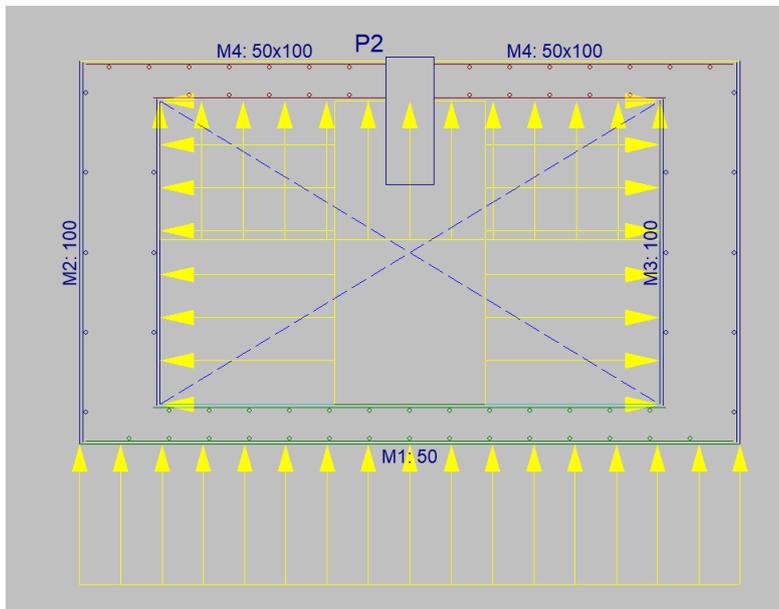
Cargas en la situación en que no se han terminado los rellenos.
